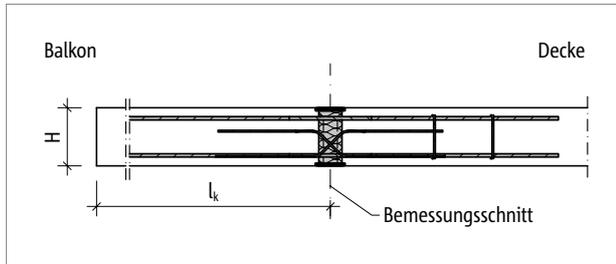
Schöck Isokorb® T Typ DP: Statisches System
